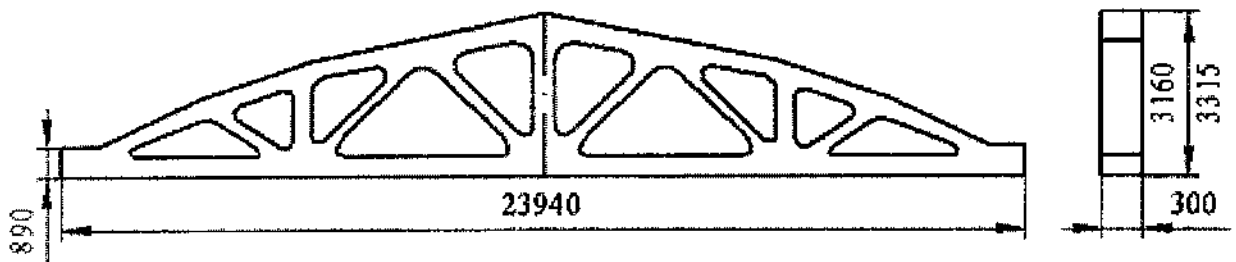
Габаритные размеры железобетонных ферм
